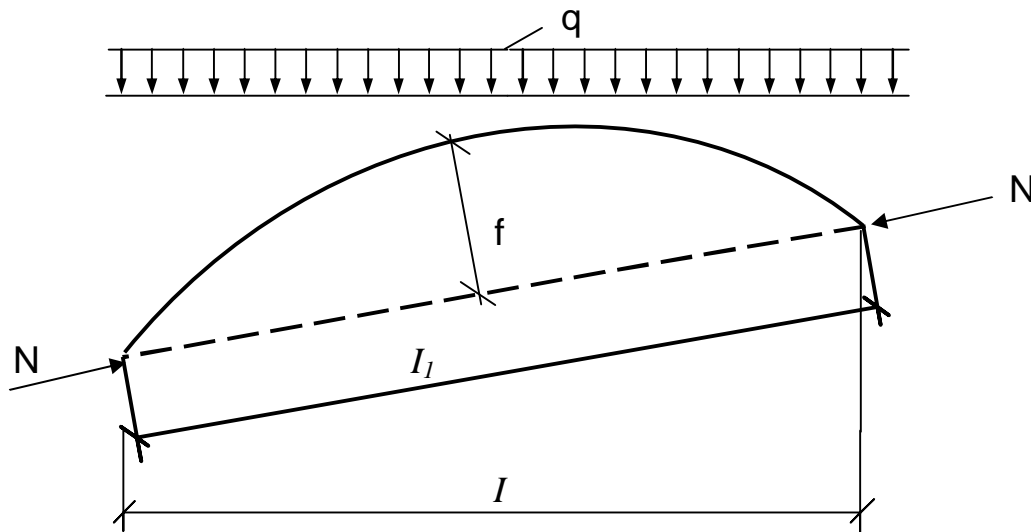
Расчётная схема панели верхнего пояса сегментной фермы
